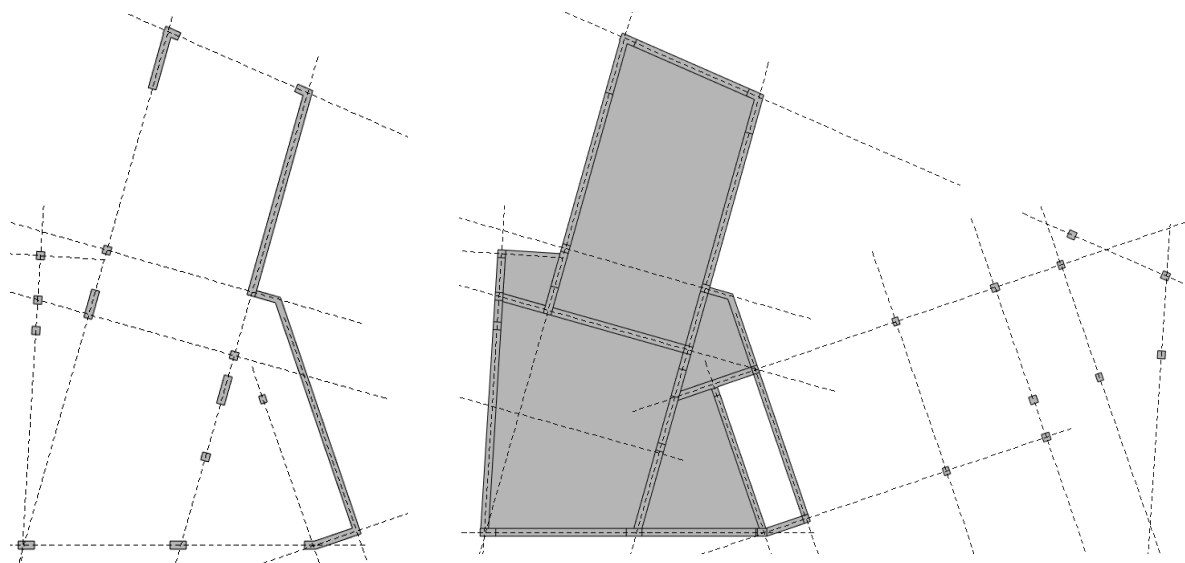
Plantas estruturais dos pisos 0 e 1.
